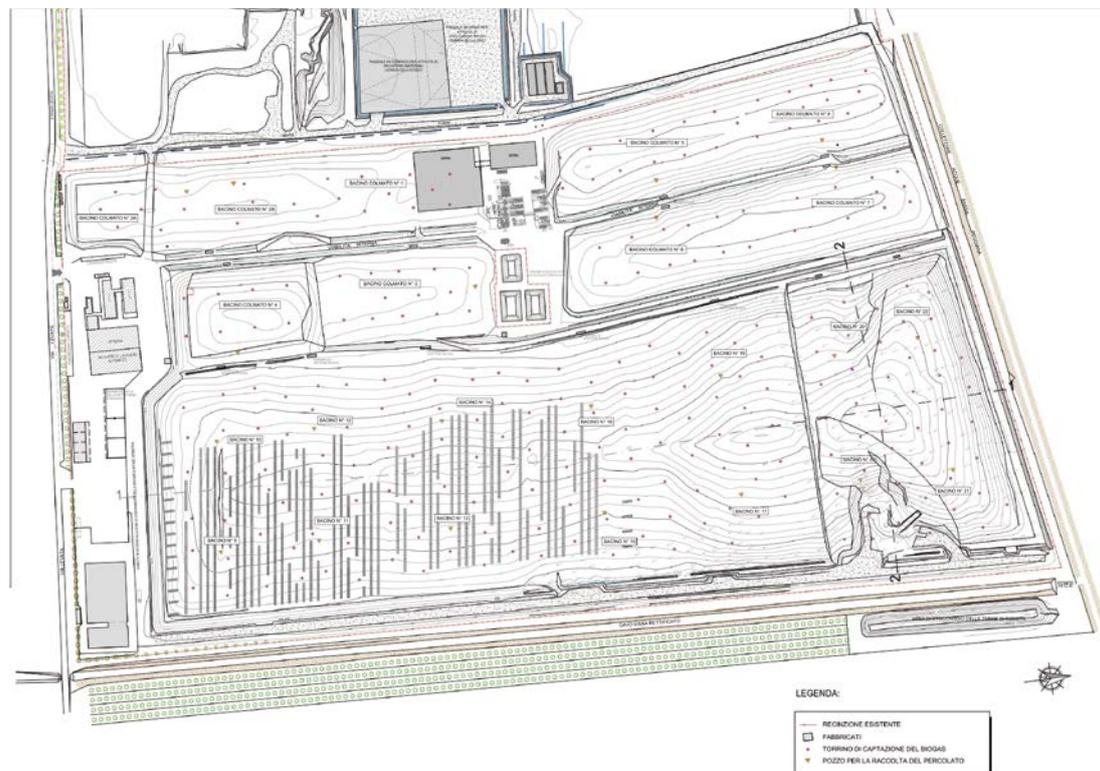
Planimetria S.a.ba.r. al 31/12/19
